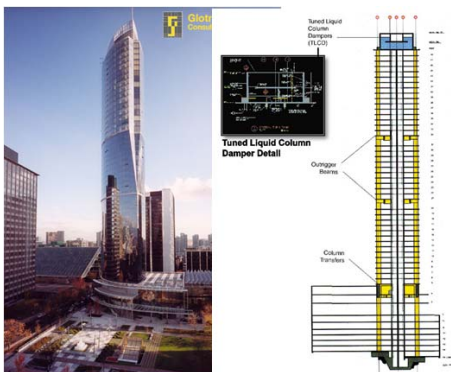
One Wall Center (TLCD, 밴쿠버, 2001년)
